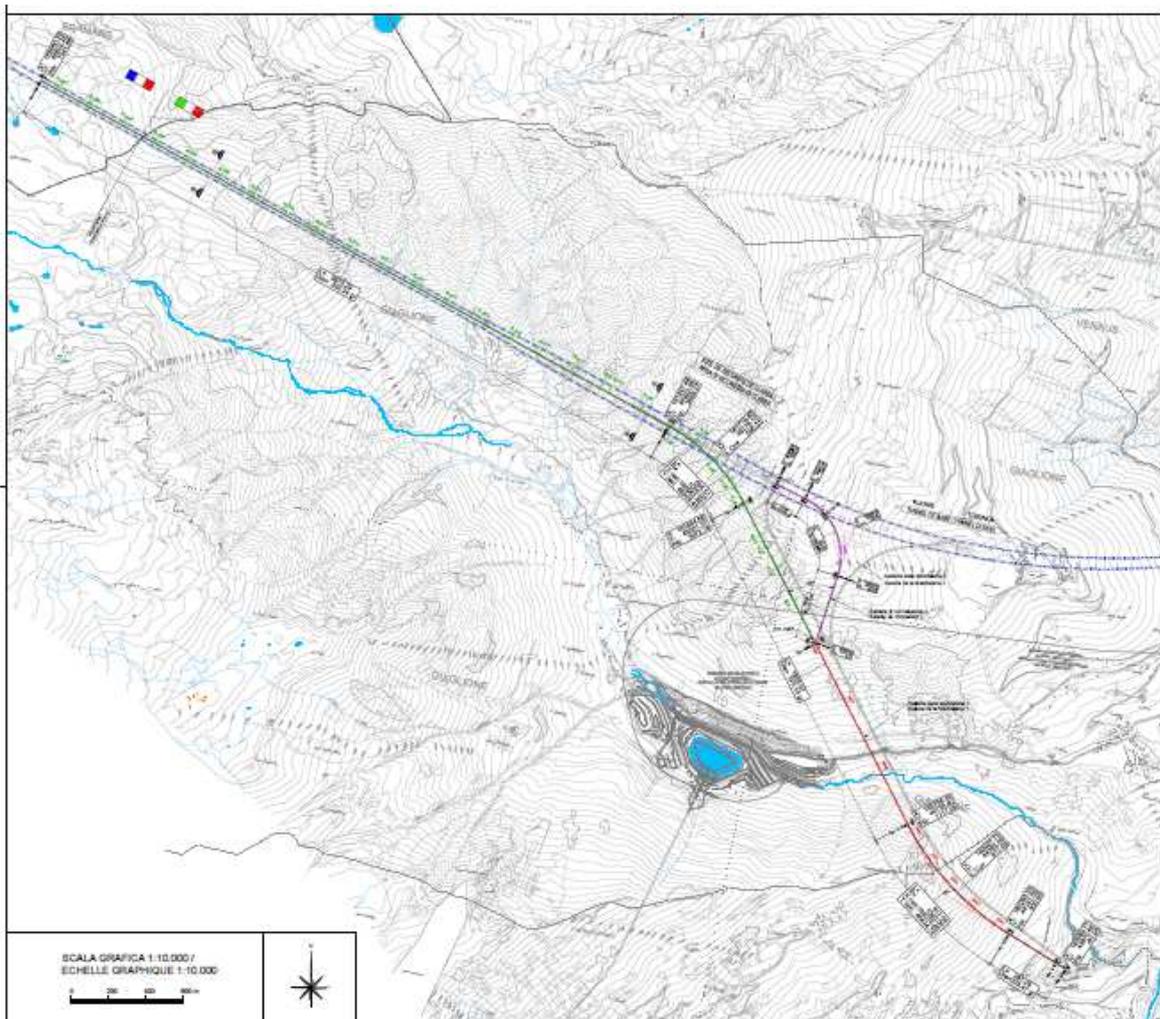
Planimetria della Galleria Maddalena 1 e della galleria di Connessione 1
